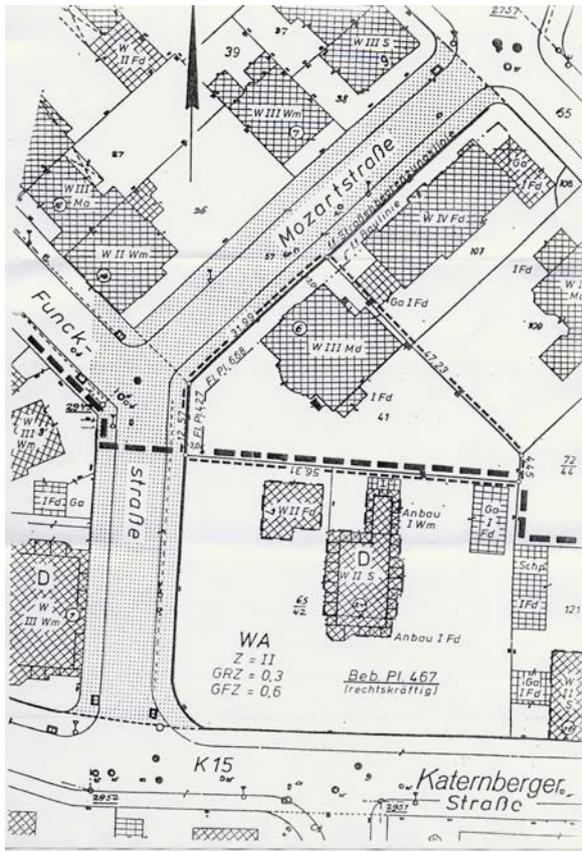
Haus Ernst, Mozartstraße 6, Lageplan, o. J.
